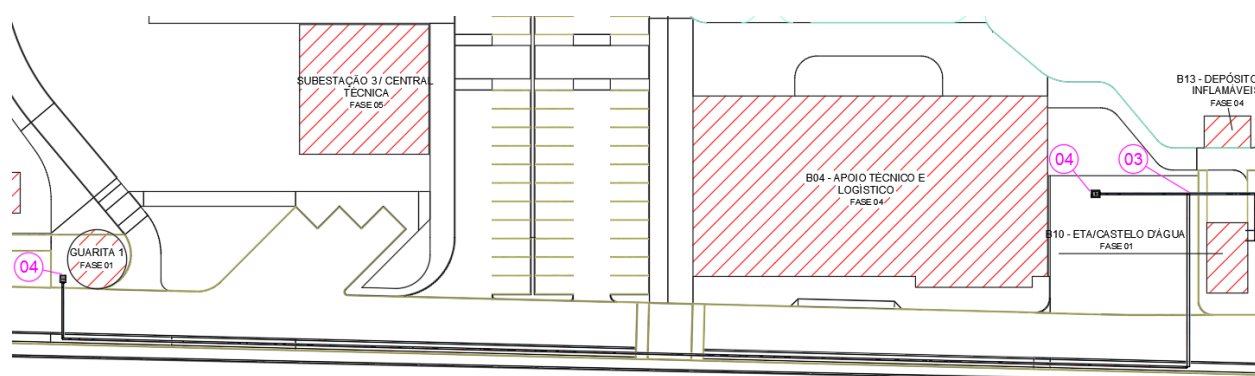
Planta trecho (Castelo d'água / Bloco B04 – Guarita 01)
